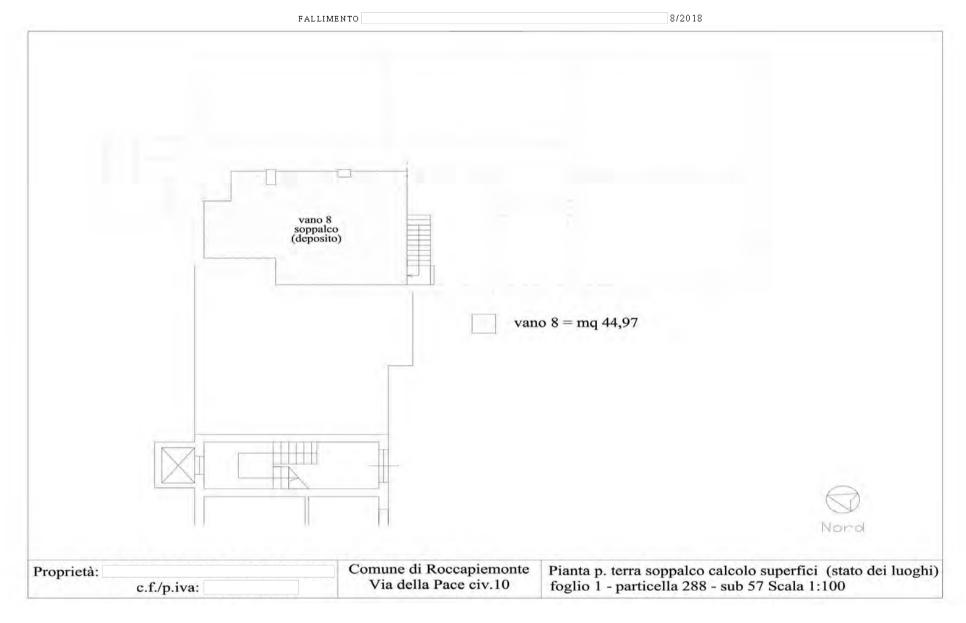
rappresentazione planimetrica particella con calcolo delle superfici locale commerciale (soppalco) fgl.1 p.lla 488 sub 57
